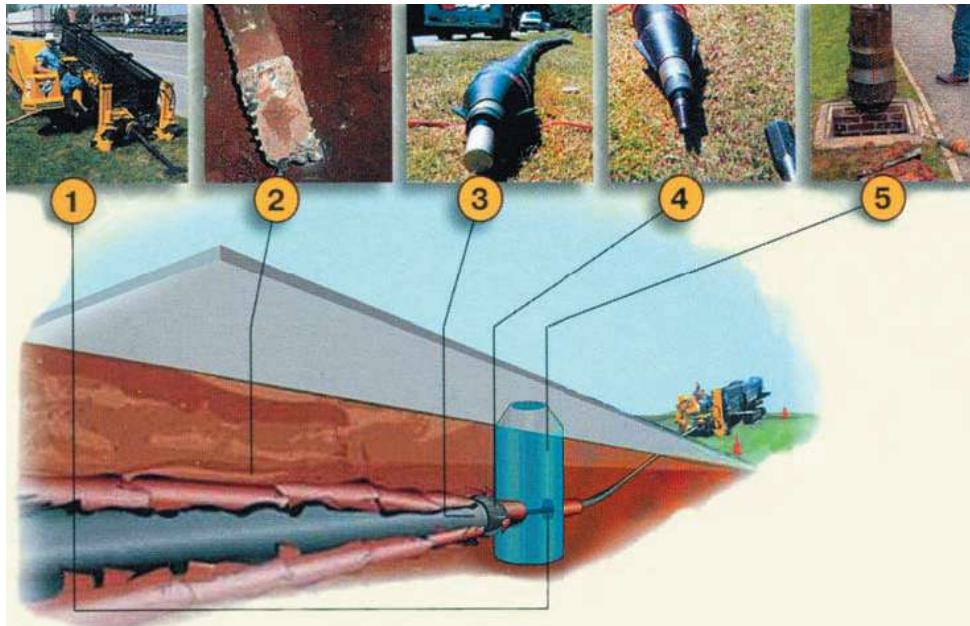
Принцип роботи устаткування IMPACTOR
